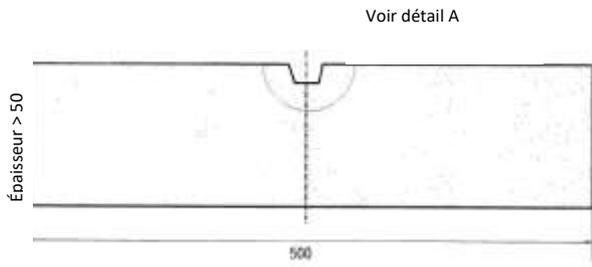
Sto-Panneaux pour Bossage Type I (dimensions en mm)
